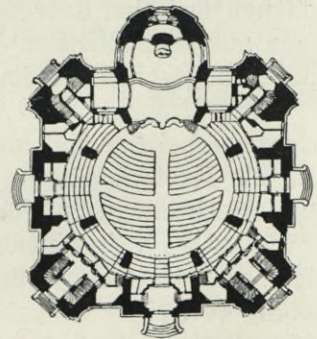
Grundriß der Frauenkirche zu Dresden.<sup>149)</sup>
